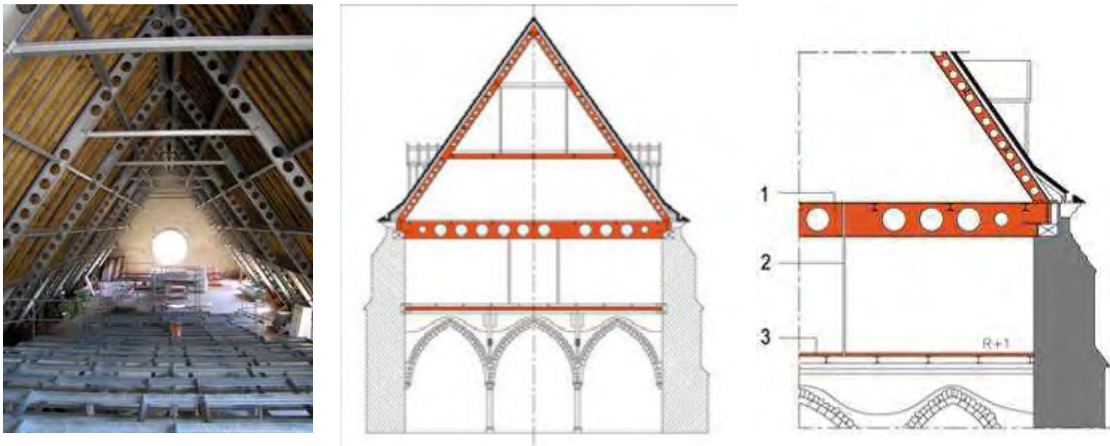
Elevação do edifício principal e os detalhes do apoio da nova estrutura (fonte: www.constructalia.com – acessado em 13/12/2011).
